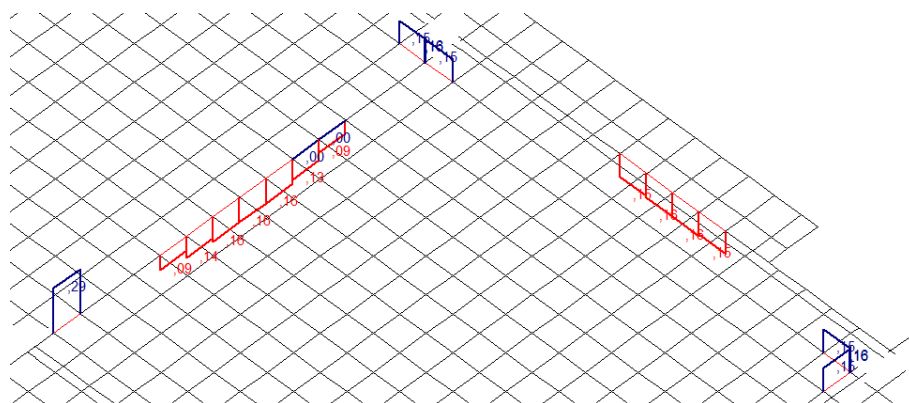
Ampliação da abertura de fissuras no pavimento PT1 da Solução Convencional com abertura máxima de 0,29 mm
